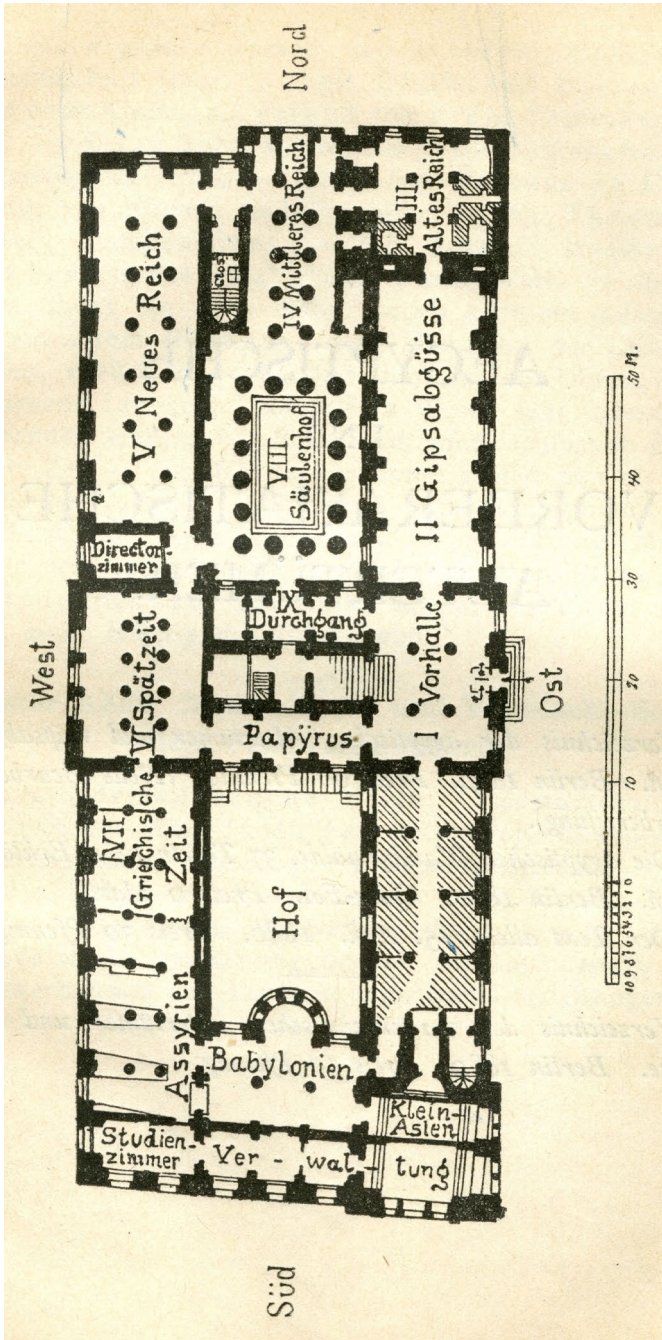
Neues Museum, Grundriss um 1891
